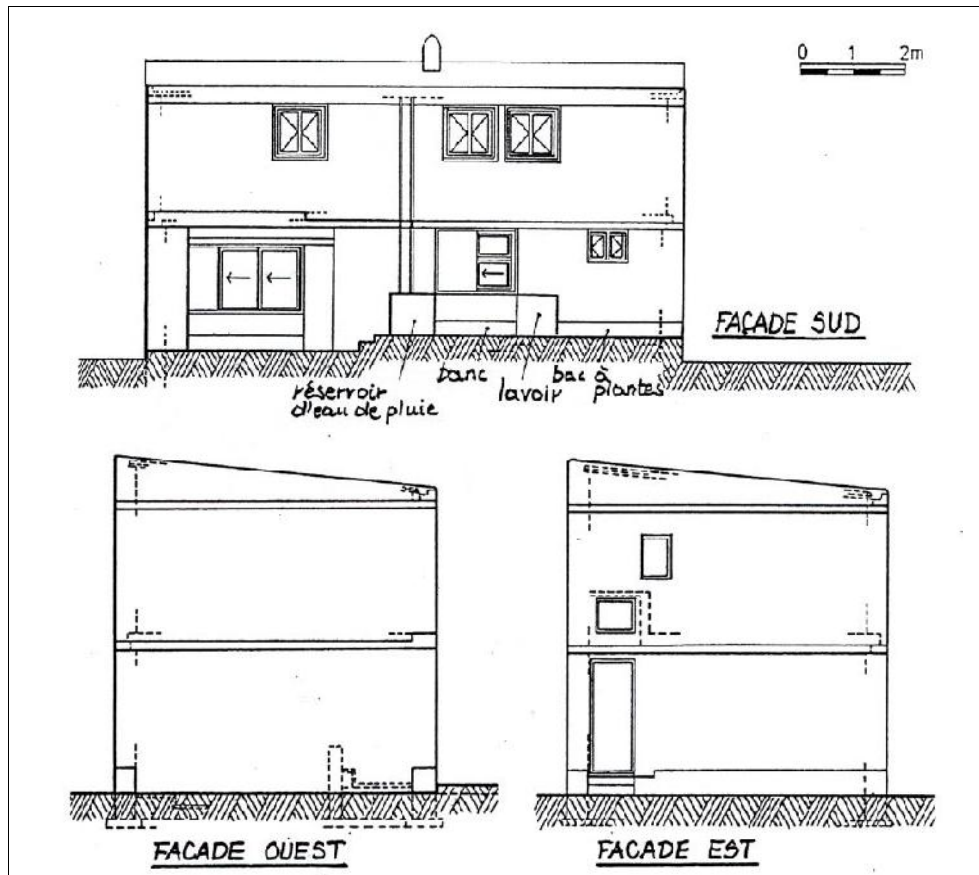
Façades types d'une construction en pisé au village Mostefa Ben Brahim [Doat et al, 1979].
